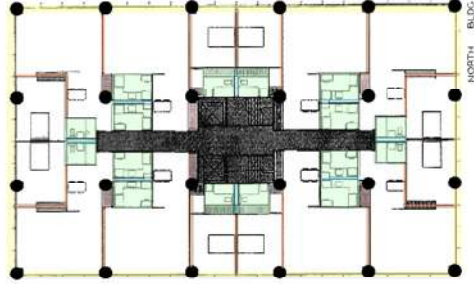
Planta Pavimentos Tipo Bloco Norte e Sul E: 1/200
